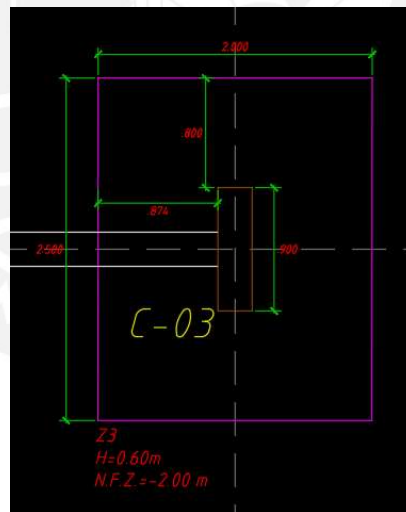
Vista en planta Z3 indicando dimensión de volados
